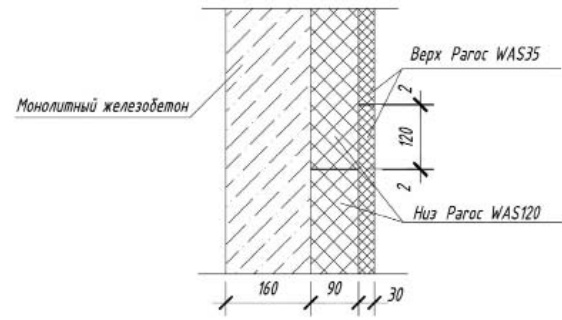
Узел № 2. Учёт зазора в теплоизоляции шириной 2 мм с основанием из монолитного железобетона. Вариант 2
